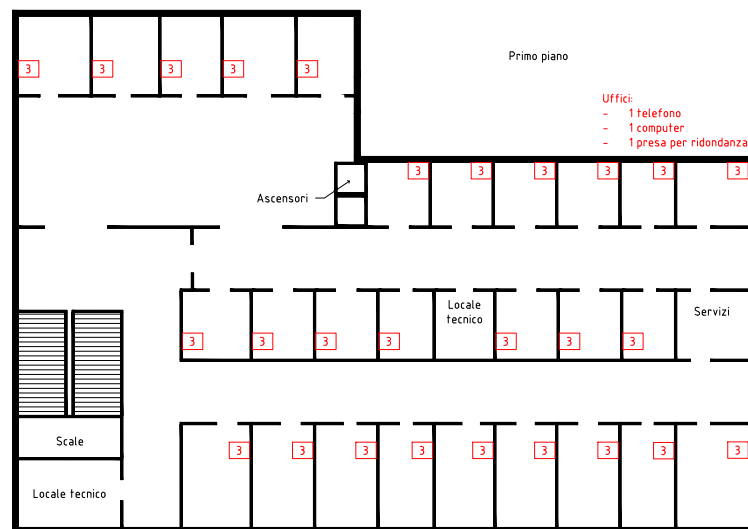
Planimetria del primo piano e dei successivi, comprensivi di posizionamento e conteggio delle prese multiuso.
